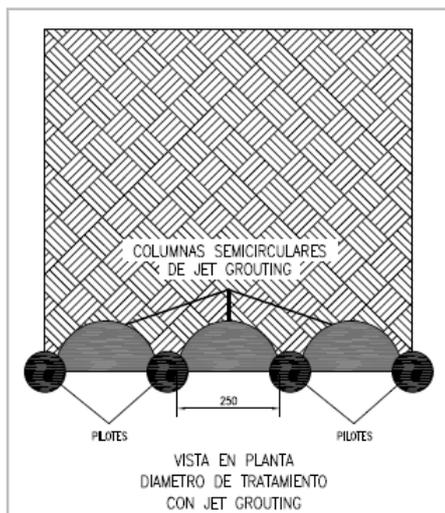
y 7: Esquema conceptual de la solución de Jet Grouting entre pilotes.
